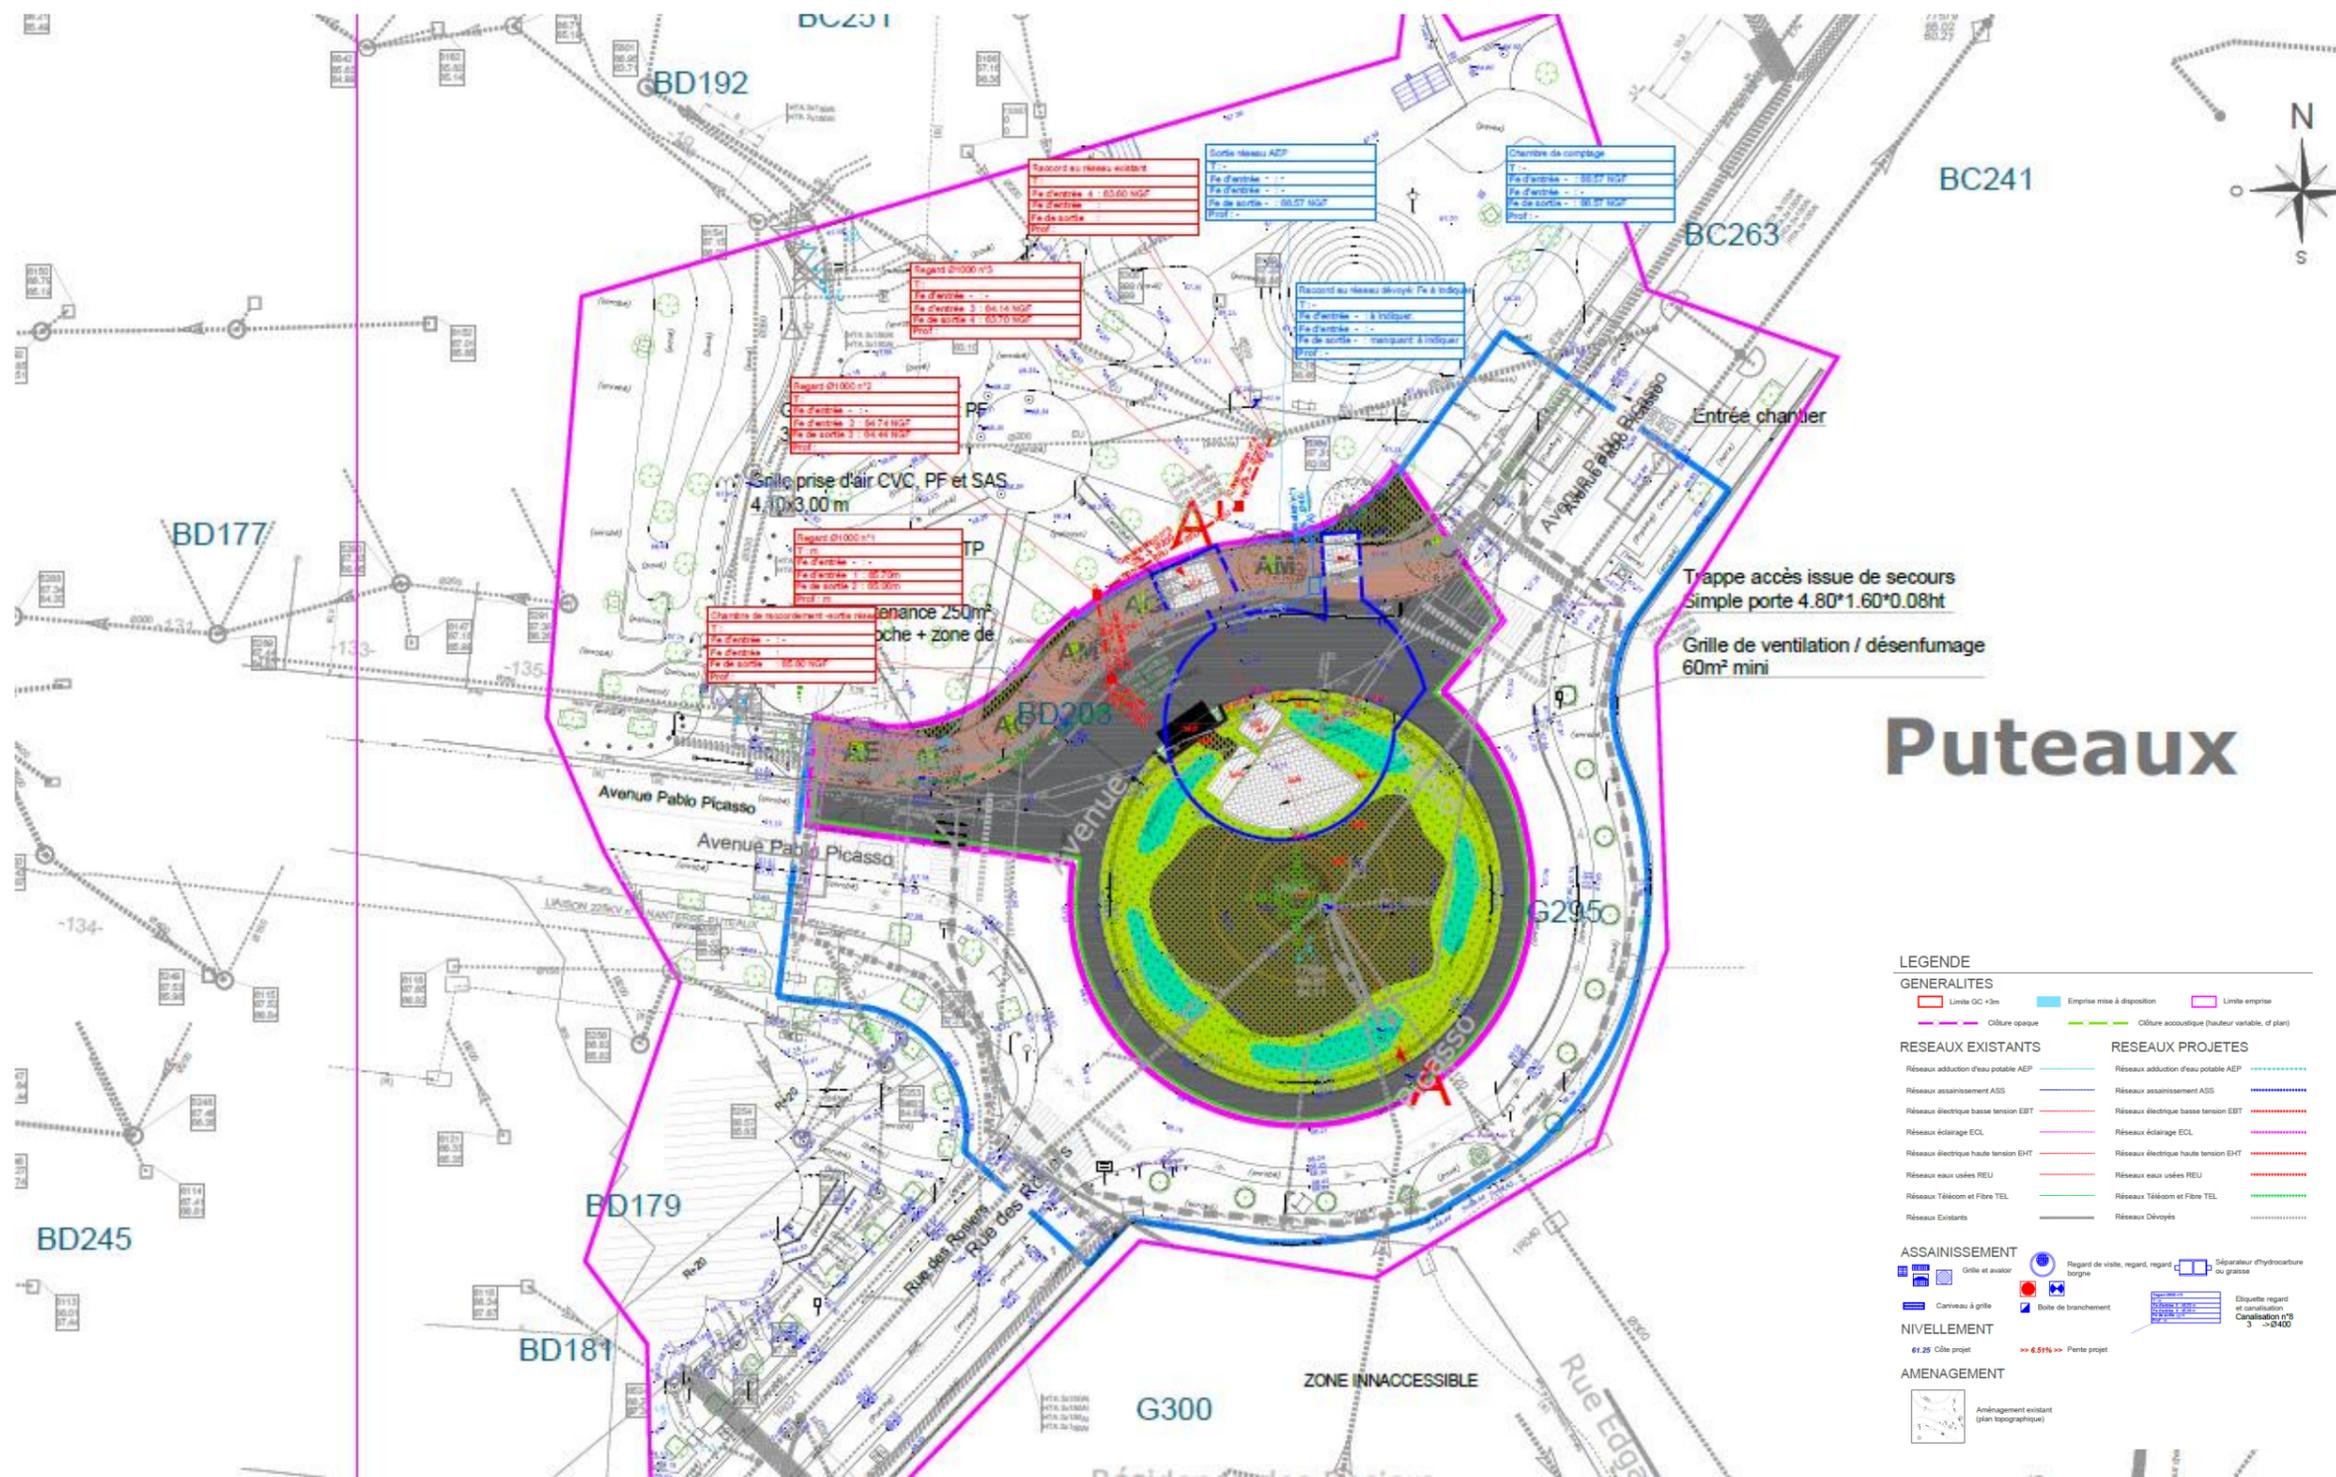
Plan d’assainissement de l’OA 2703P (Source : Groupement Intencités 15, 2023)
